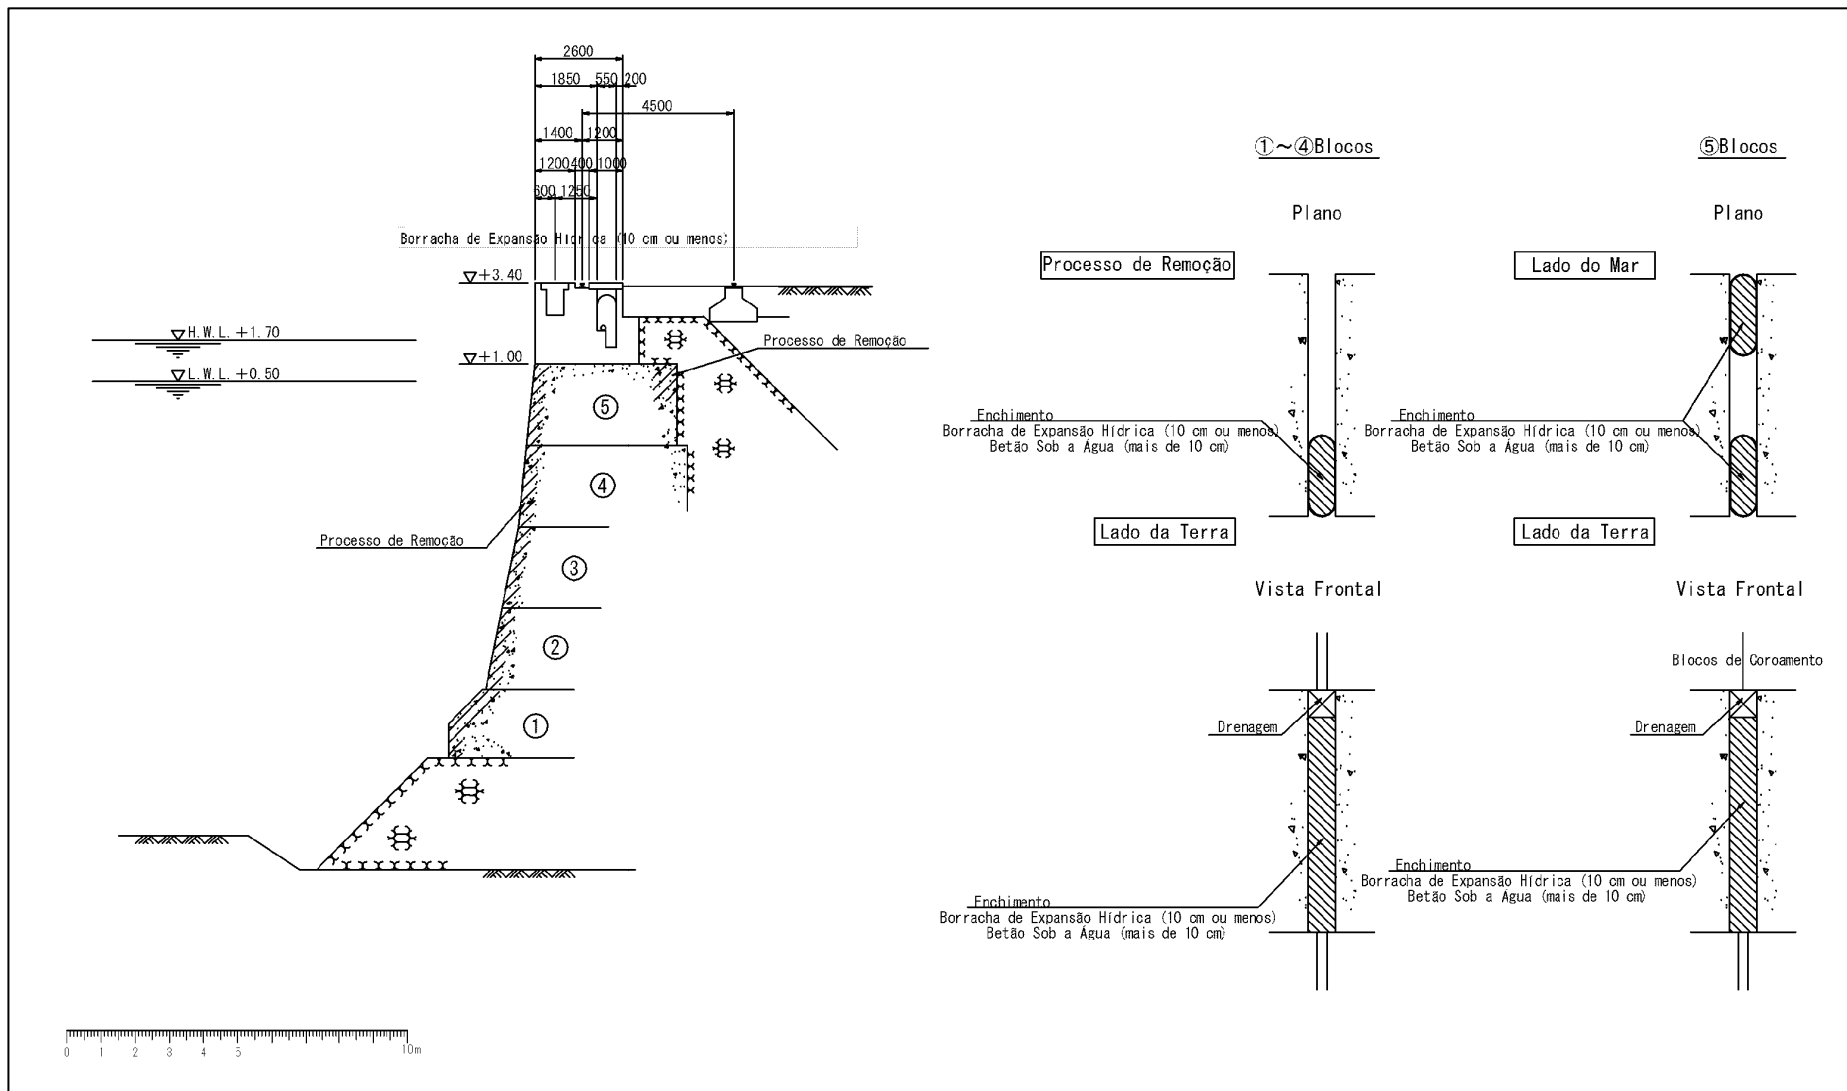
Planta Ilustrativa do Processo de Reabilitação dos Blocos do Muro
